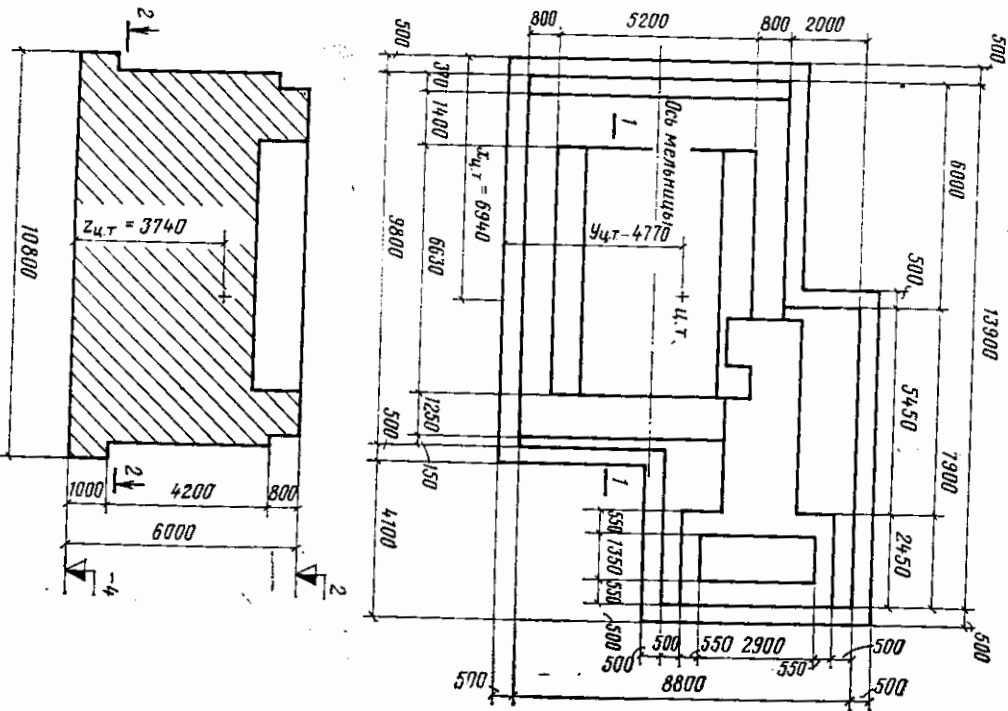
Массивный фундамент под мельницу (план и разрез)
